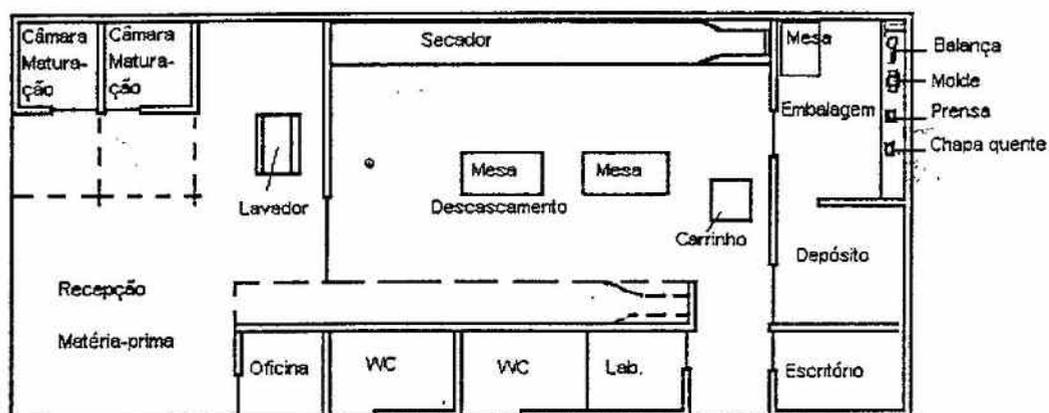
Planta baixa básica de uma unidade industrial para processamento de banana-passa.
